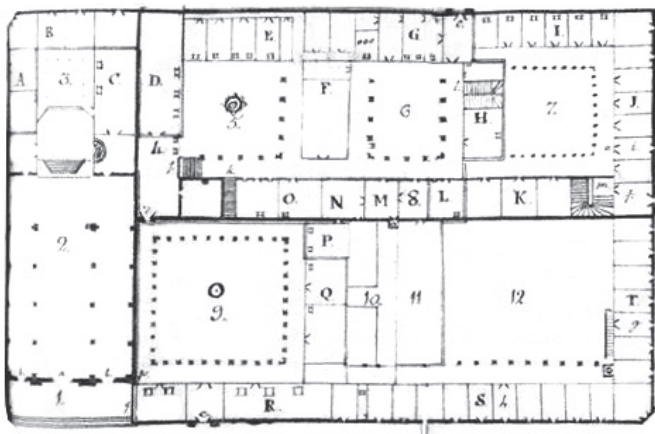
Plano de planta baja de las edificaciones existentes hasta antes de 1915
